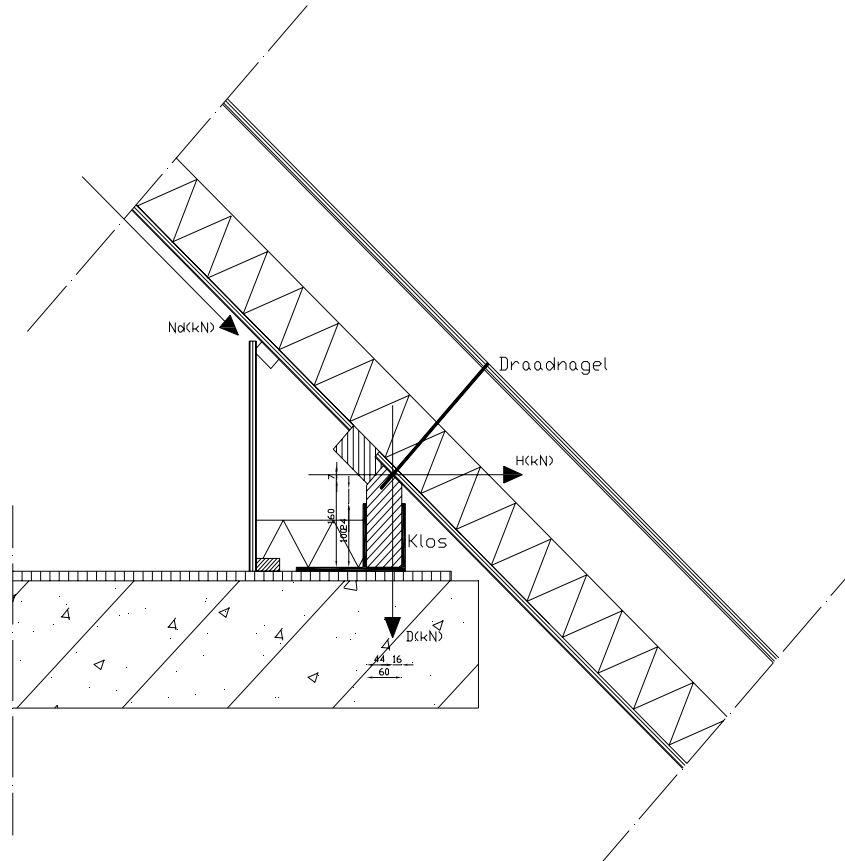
is het detail rechtsonder bij de aansluiting betonvloer en onderzijde dak. Het detail staat in aansluiting met staaf 3 en de betonvloer.
